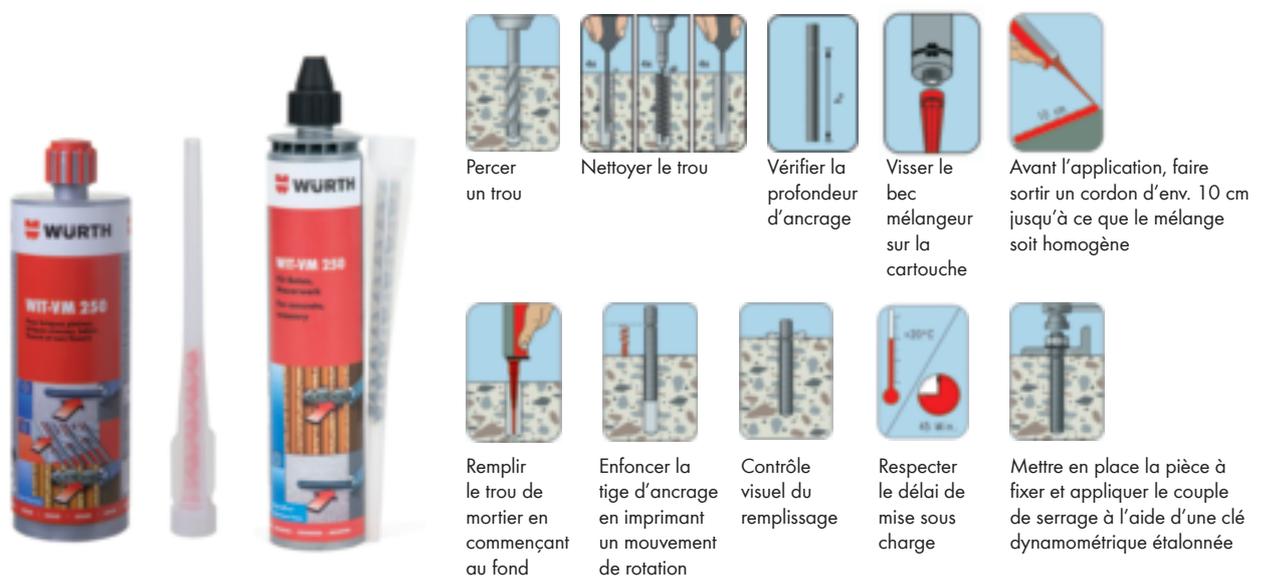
montage affleurant de la cheville Würth WIT-VM 250 sur béton non fissuré.
